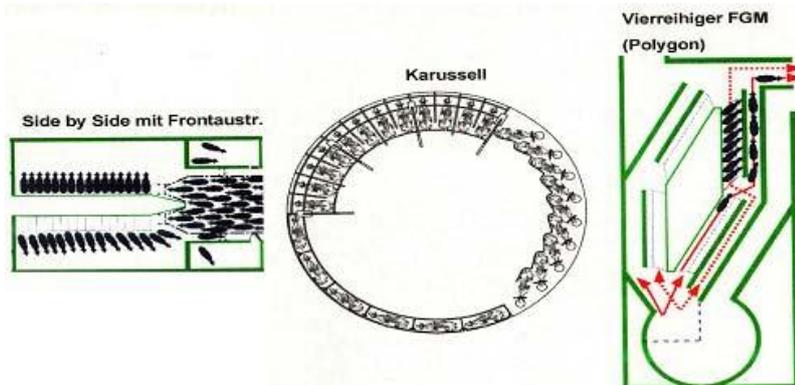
Grundrisse verschiedener Melkstände
